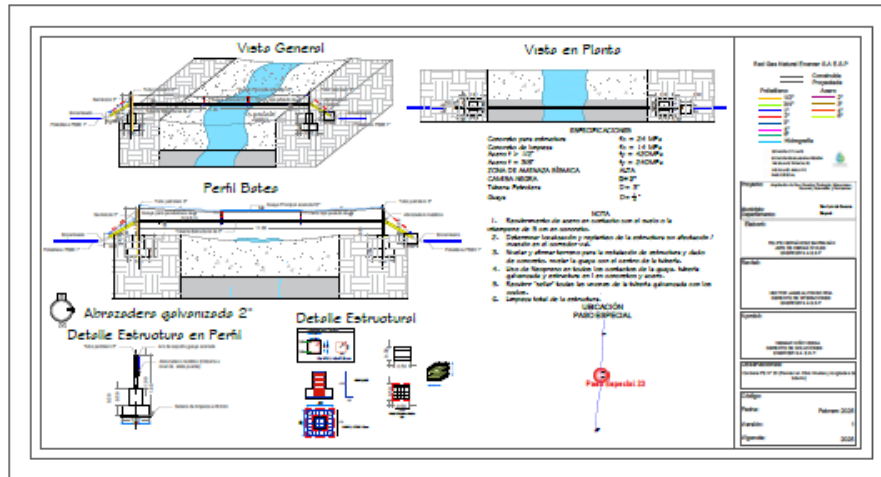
Plano 3.8 Tubería Galvanizada 2" 11 m TPE 1" Batea Plano
